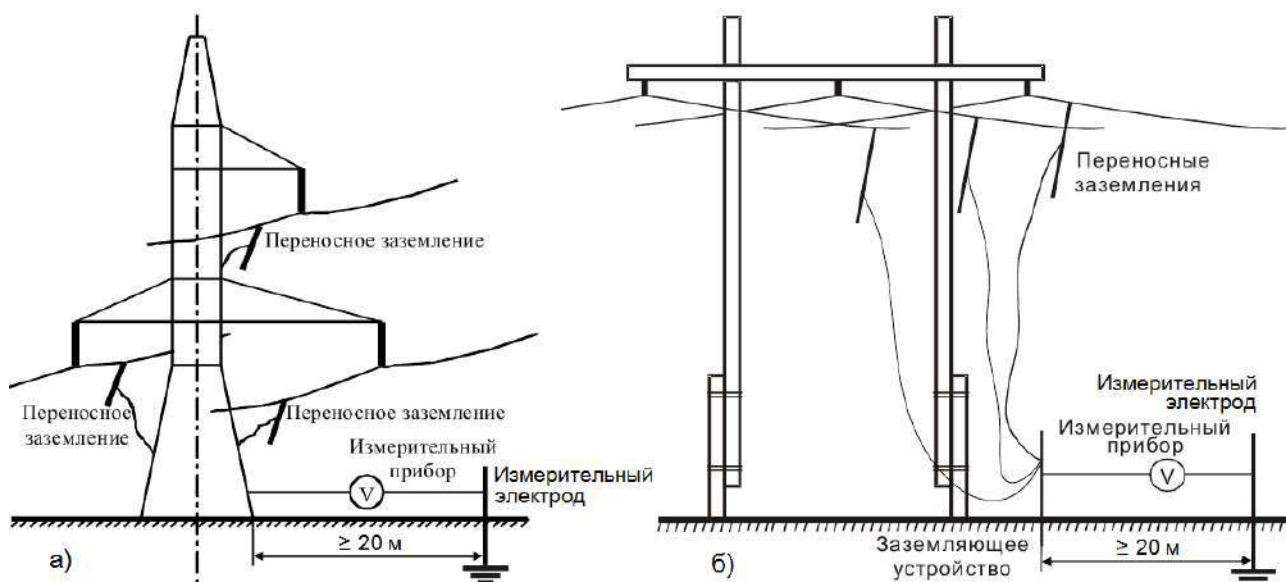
Схемы измерений наведенного напряжения и установки заземлений на рабочем месте: а – металлическая или железобетонная опора; б – деревянная опора (без заземляющего спуска)
